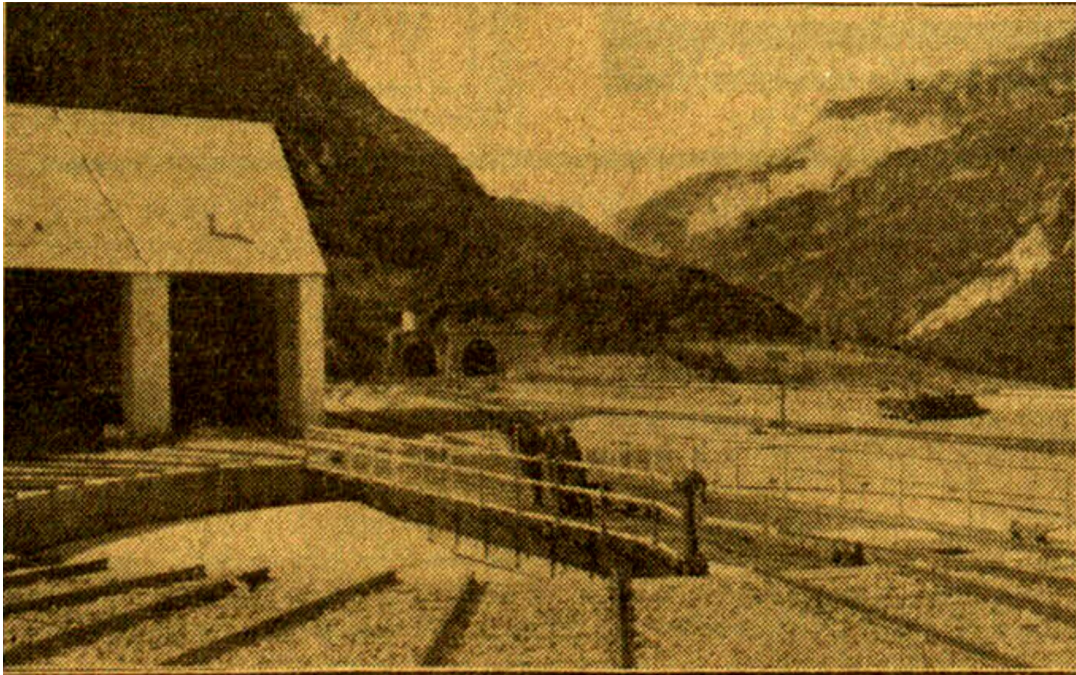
Puente giratorio de 23 m de diámetro construido en Talleres Astillero S.A. recién montado. Imagen extraída de La Nación, Madrid, 07 - 03 - 1928, p. 6.
